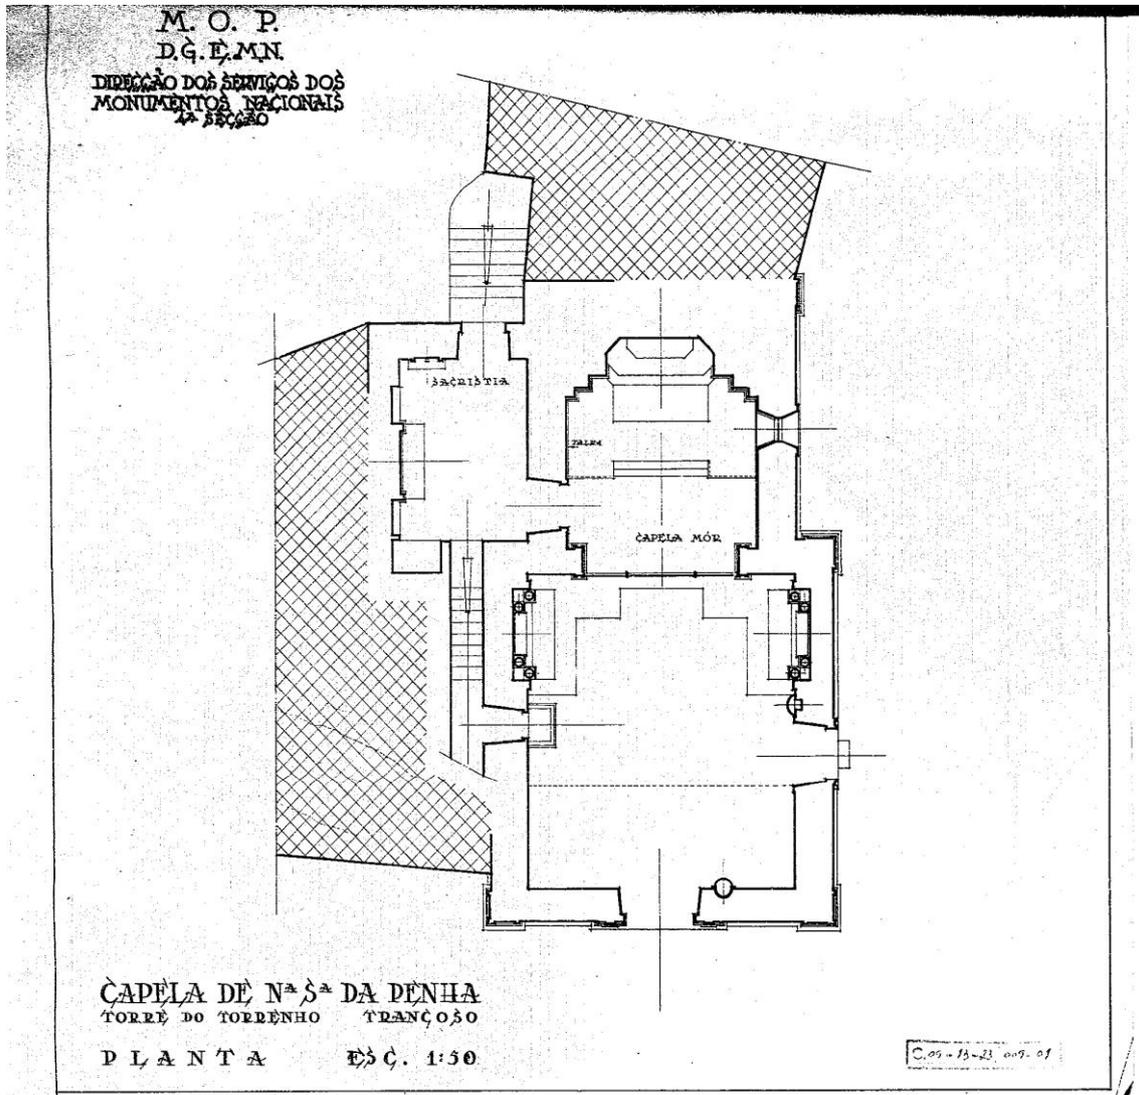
Planta da capela do solar. Foto IGESPAR.
